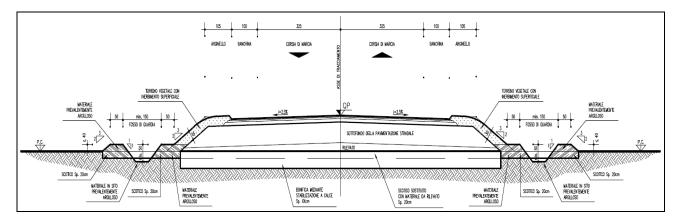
SEZIONE TIPO STRADA COMUNALE FANTOZZA DI NUOVA PROGETTAZIONE
